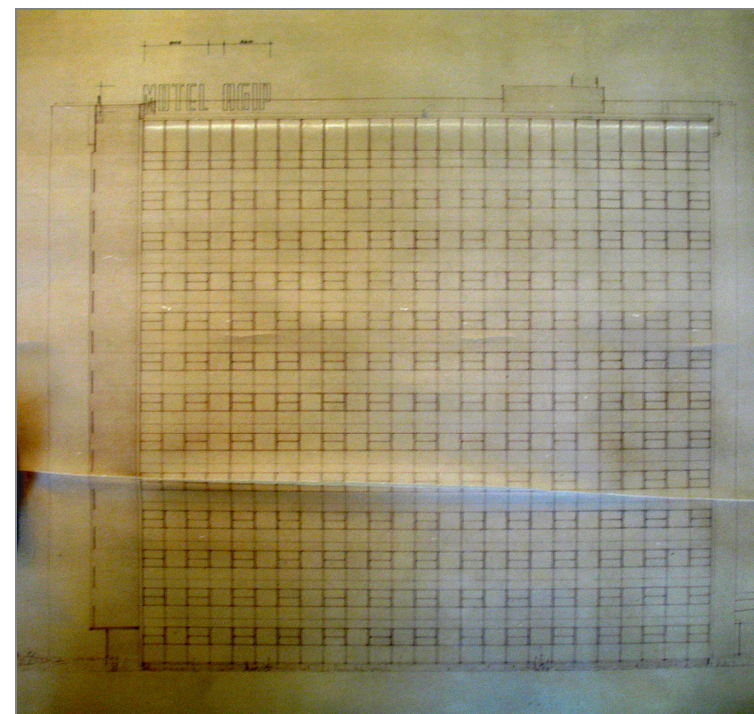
prospetto verso la città (fonte CSAC – stralcio tav. 68, archivio n. 181-2)
